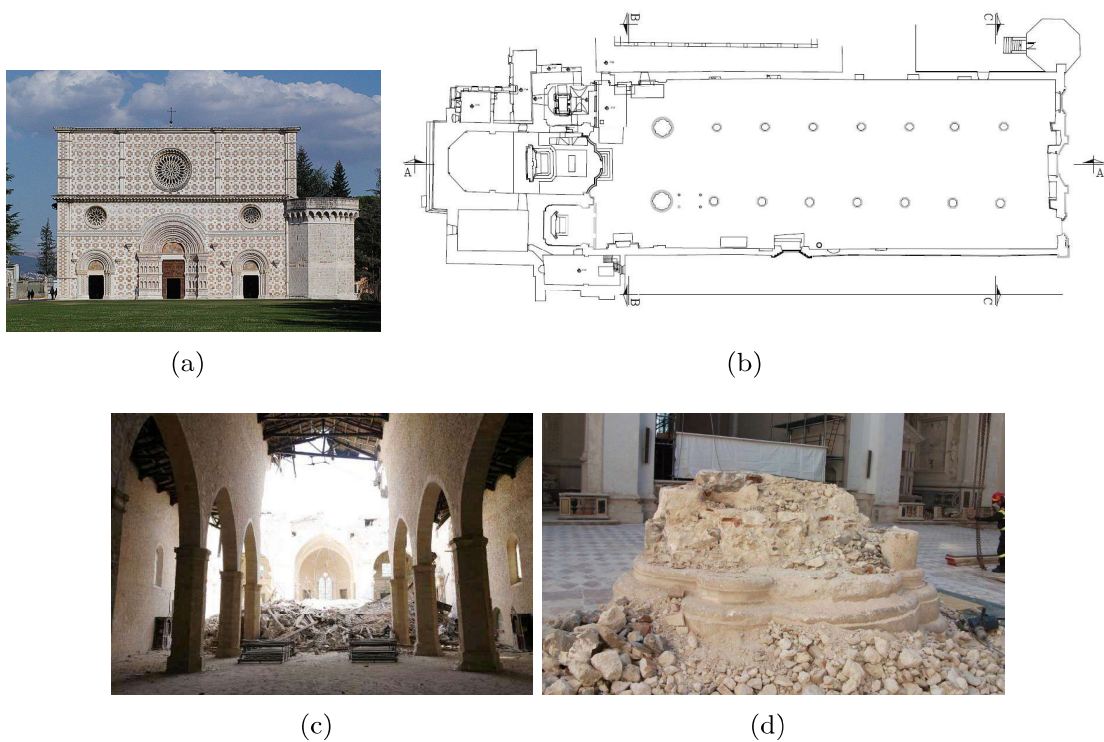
Chiesa di S. Maria di Collemaggio, L'Aquila, Abruzzo (Italia): (a) facciata, (b) pianta della chiesa, (c) transetto collassato in seguito al sisma del 2009; (d) pilastro collassato [165].
